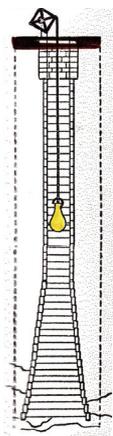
Вертикальный разрез нефтяного колодца на Бакинских промыслах, из которого нефть добывалась ручным способом
